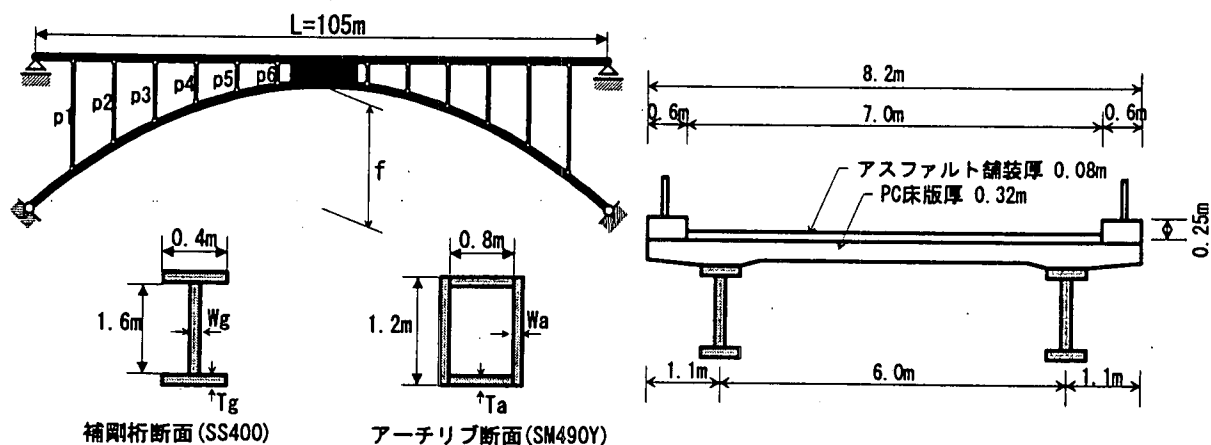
全体図 横断面図 補剛桁・アーチリブ断面図
